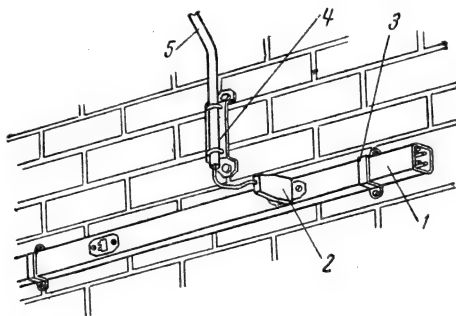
Прокладка шинопровода ШОС67 на стене на скобах.
